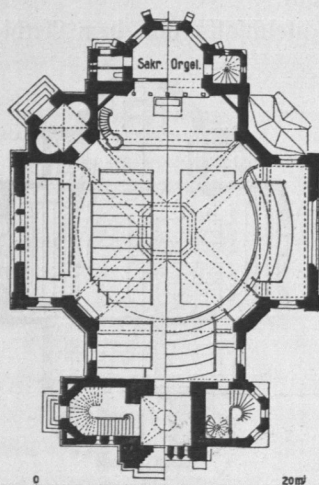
Apostelkirche in Eimsbüttel, Grundriß.
